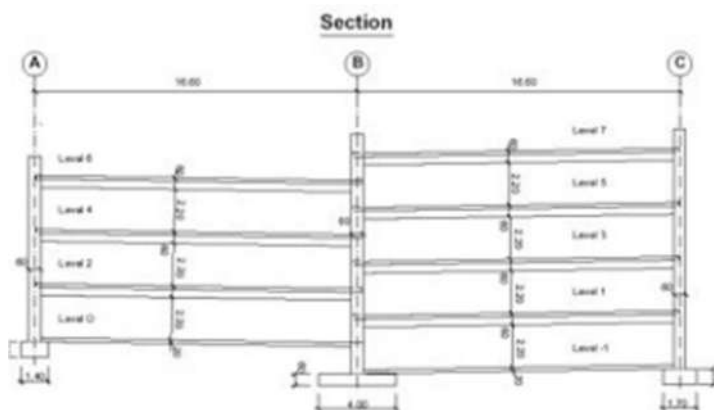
Corte del edificio GAD Munsten en la dirección paralela a las luces mayores.
